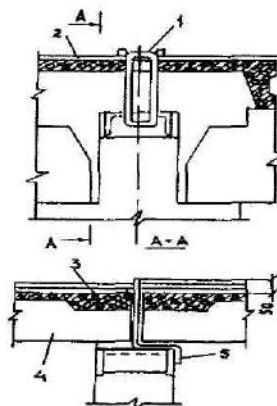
Узел в системе молниезащиты многоэтажного здания с прямоугольными железобетонными ригелями:
